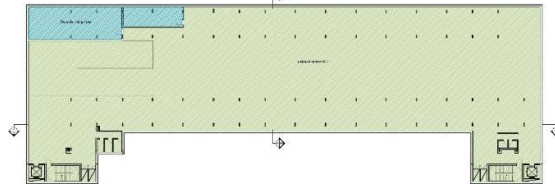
Sector estacionamiento y sala de máquinas (Ss2)
